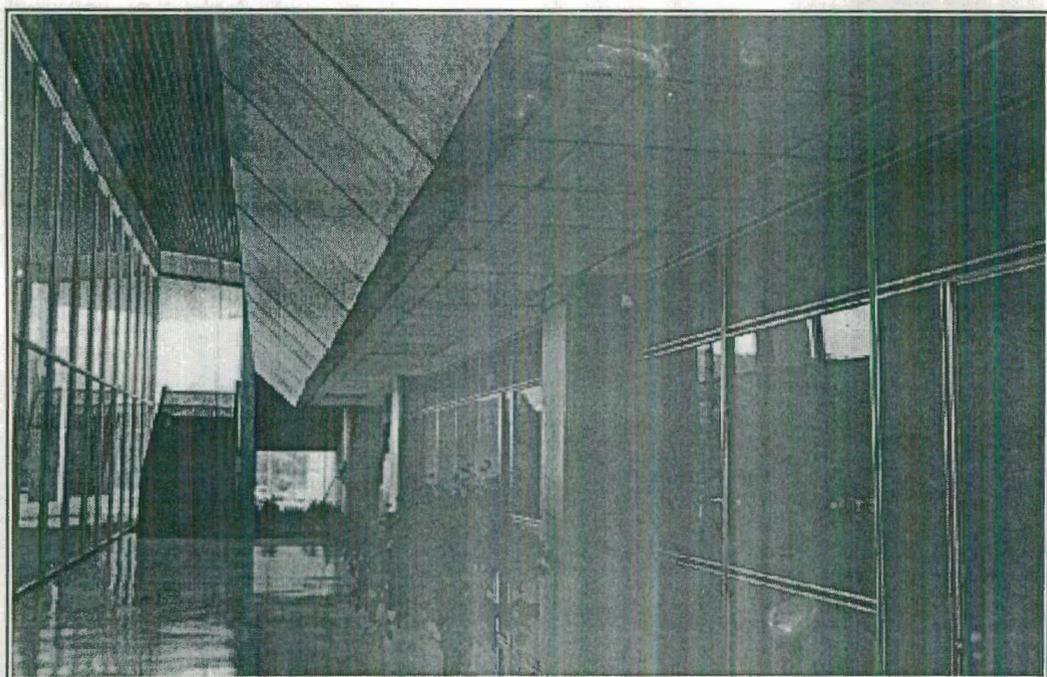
Estado de la impermeabilización de la cubierta en sector principal junto a cubierta panorámica.
